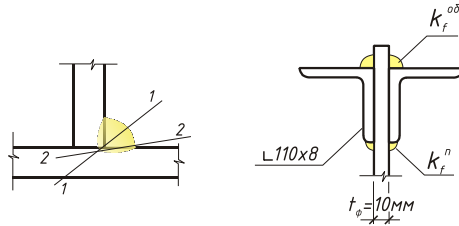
Расчетные сечения и катеты сварных швов.
